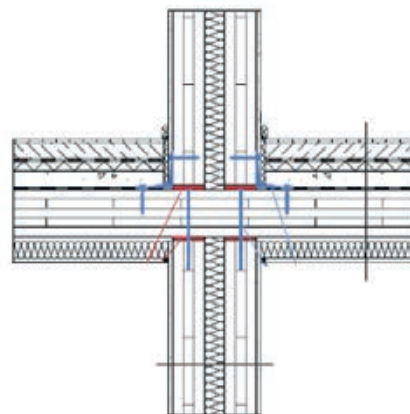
Drvena međukatna konstrukcija oslonjena na zidanu konstrukciju [292]
